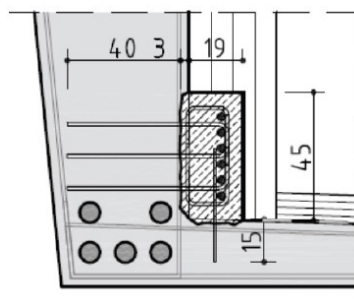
Stahlbetonbalken zur Verbesserung des Ankündigungsverhaltens [ScHe16]
